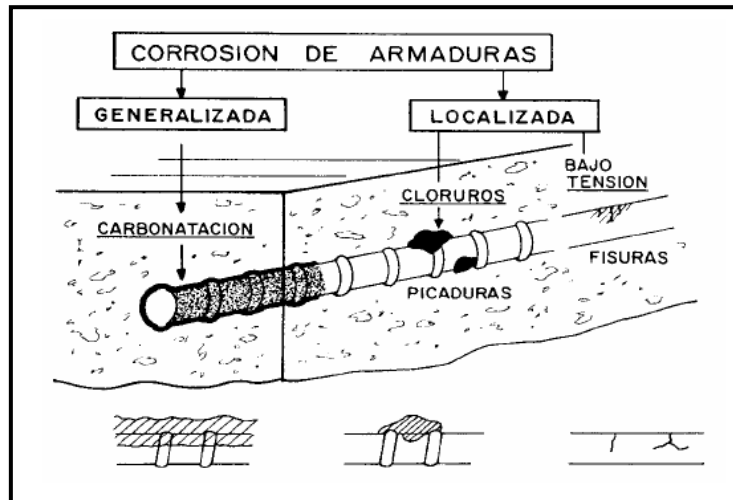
Esquema de los tipos de corrosión en el acero de refuerzo dentro del concreto reforzado [9]
